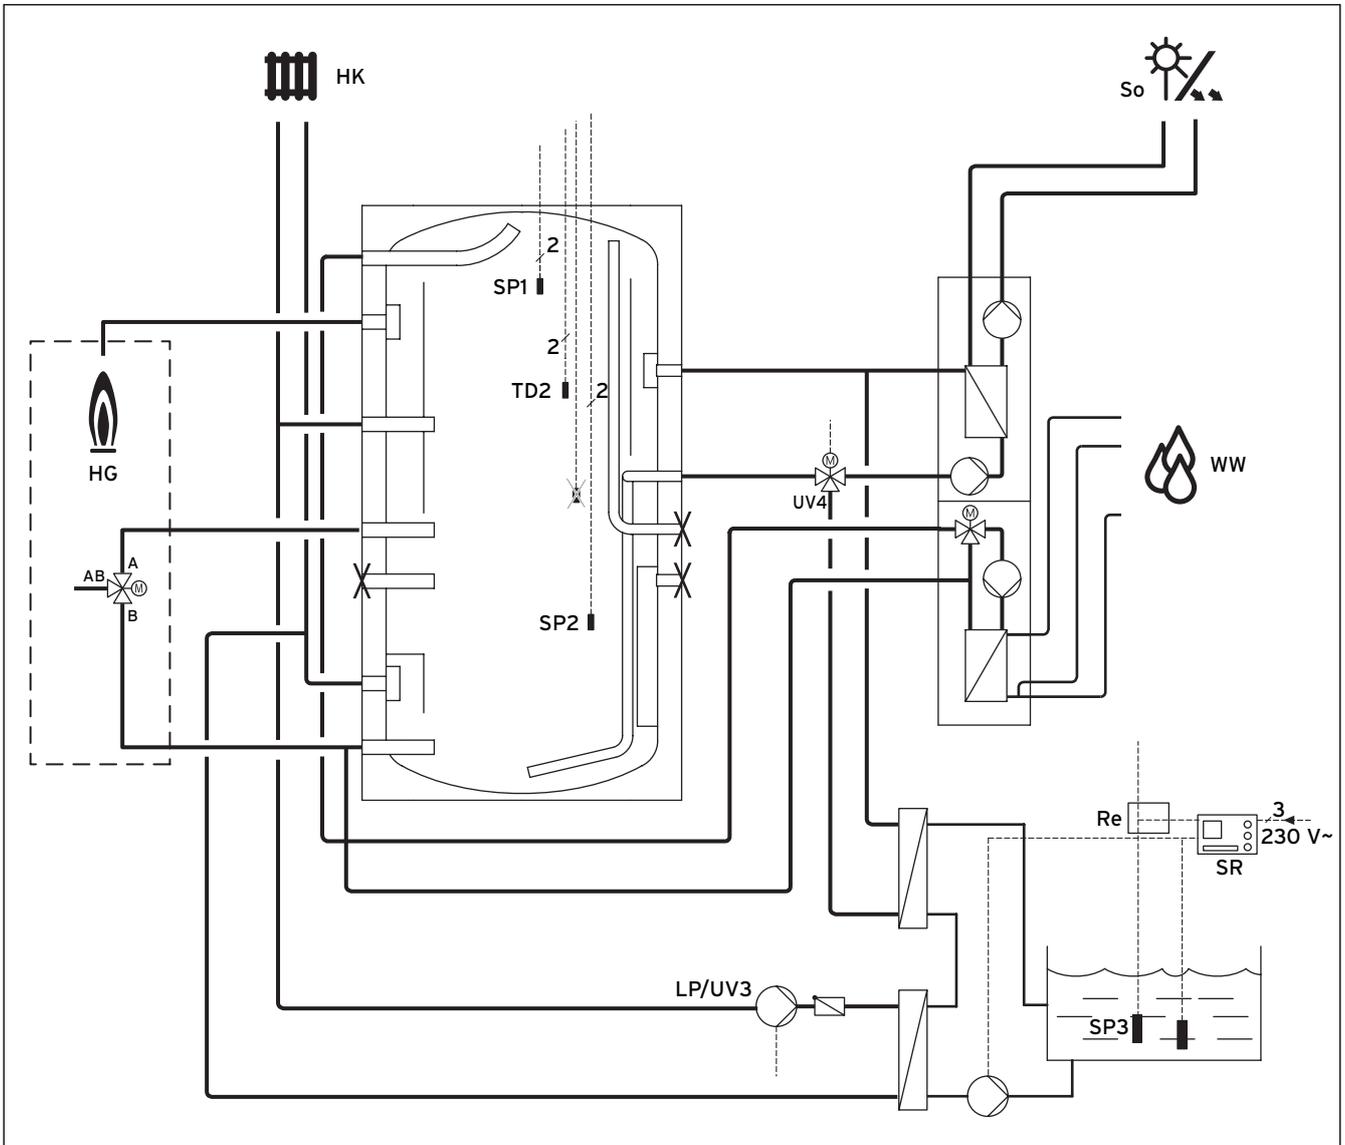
Detail-Plan Schwimmbadbeheizung
